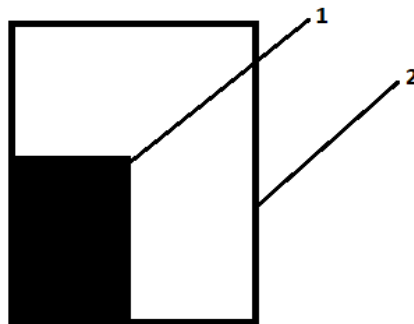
Площа поперечного перерізу, для якого наведені температурні криві.
